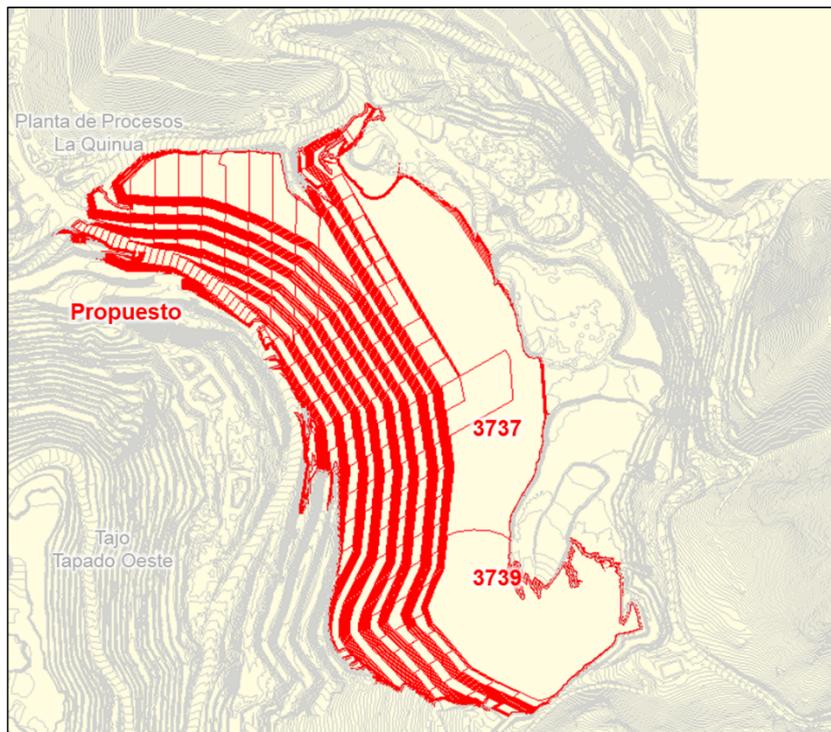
Plan de descarga del Relleno La Quinua propuesto – Año 2021 – Vista en planta
